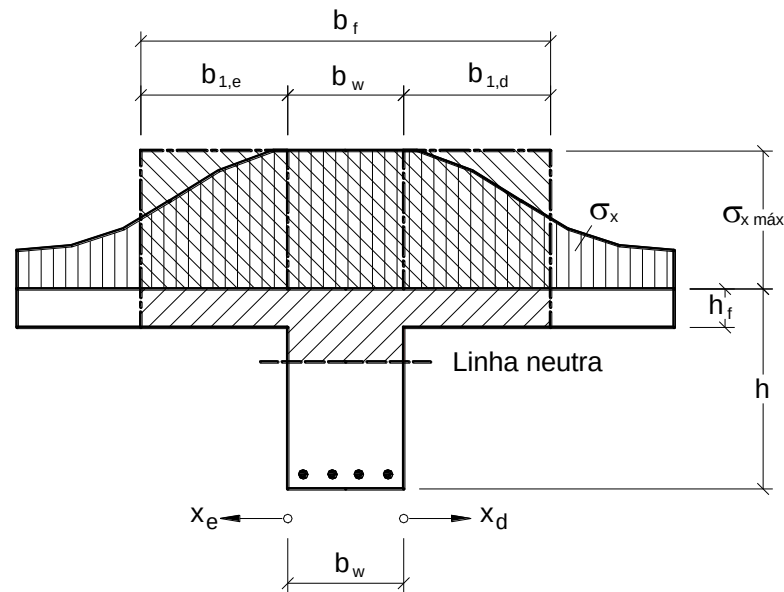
Distribuição das tensões de compressão σ_x na alma e nas lajes da seção T. (Leonhardt e Mönning, 1982).
